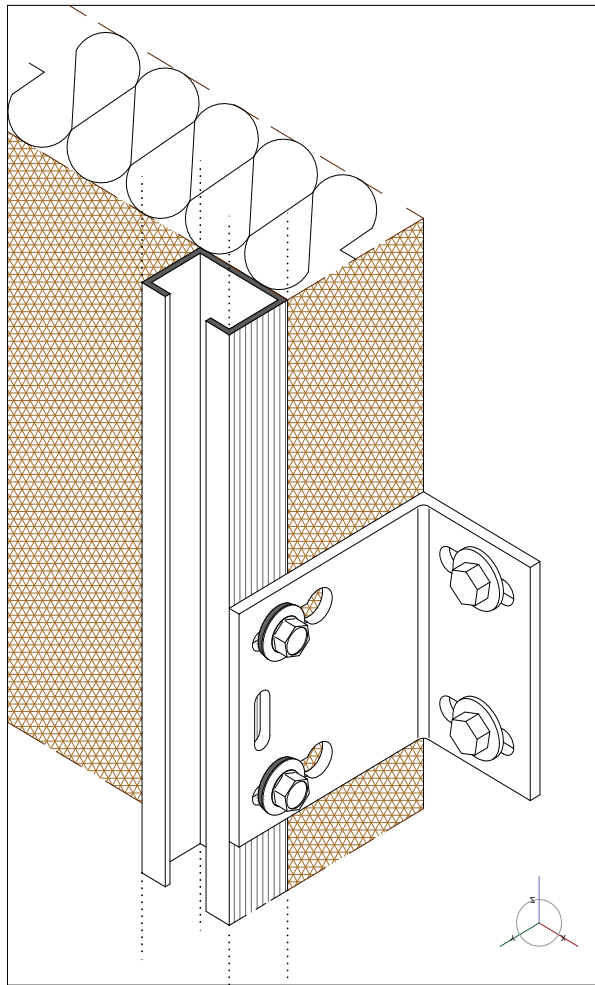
PERFIL VERTICAL "C" – SECCIÓN
